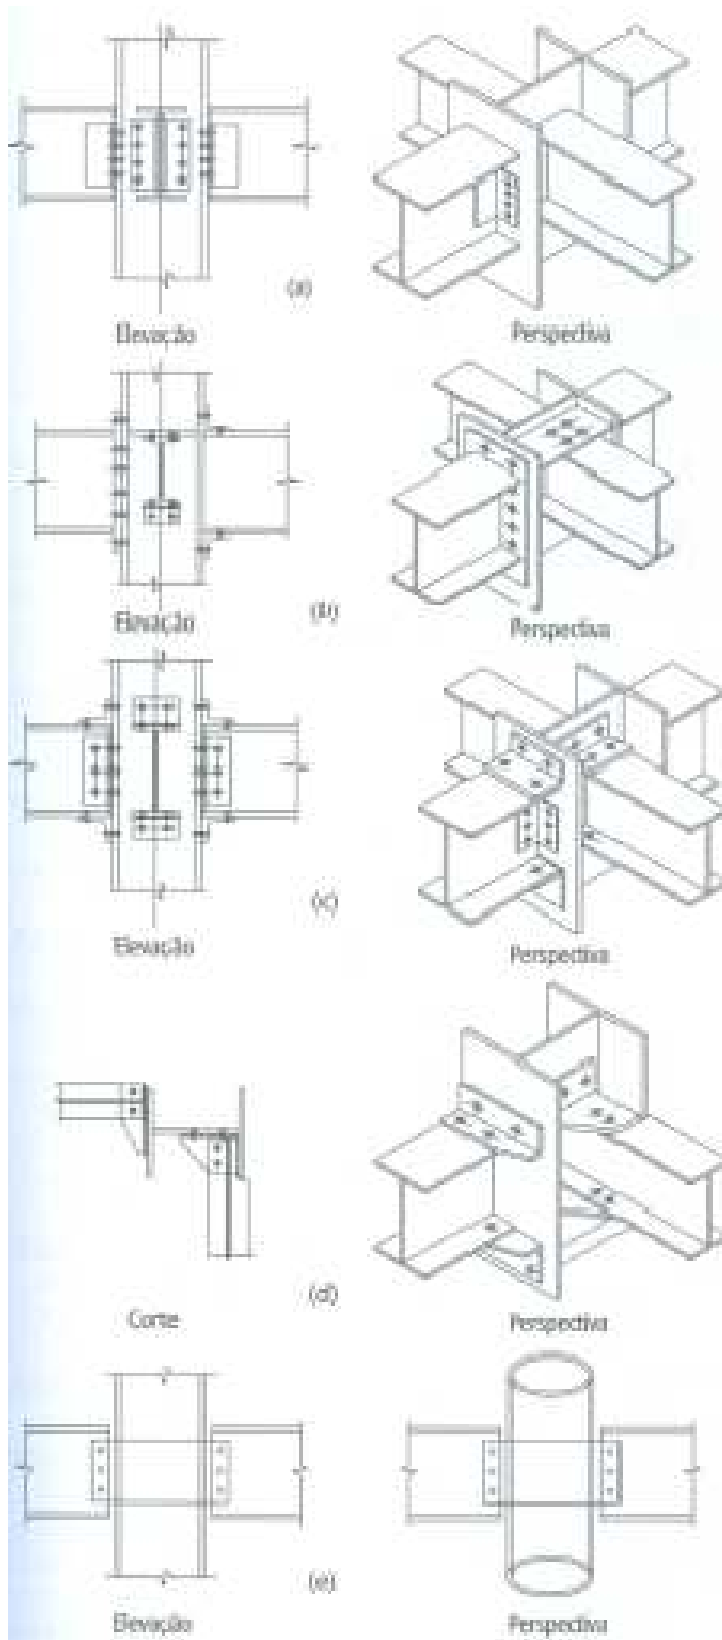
Ligações vigas com pilares parafusadas (fonte: Bellei 1986).
